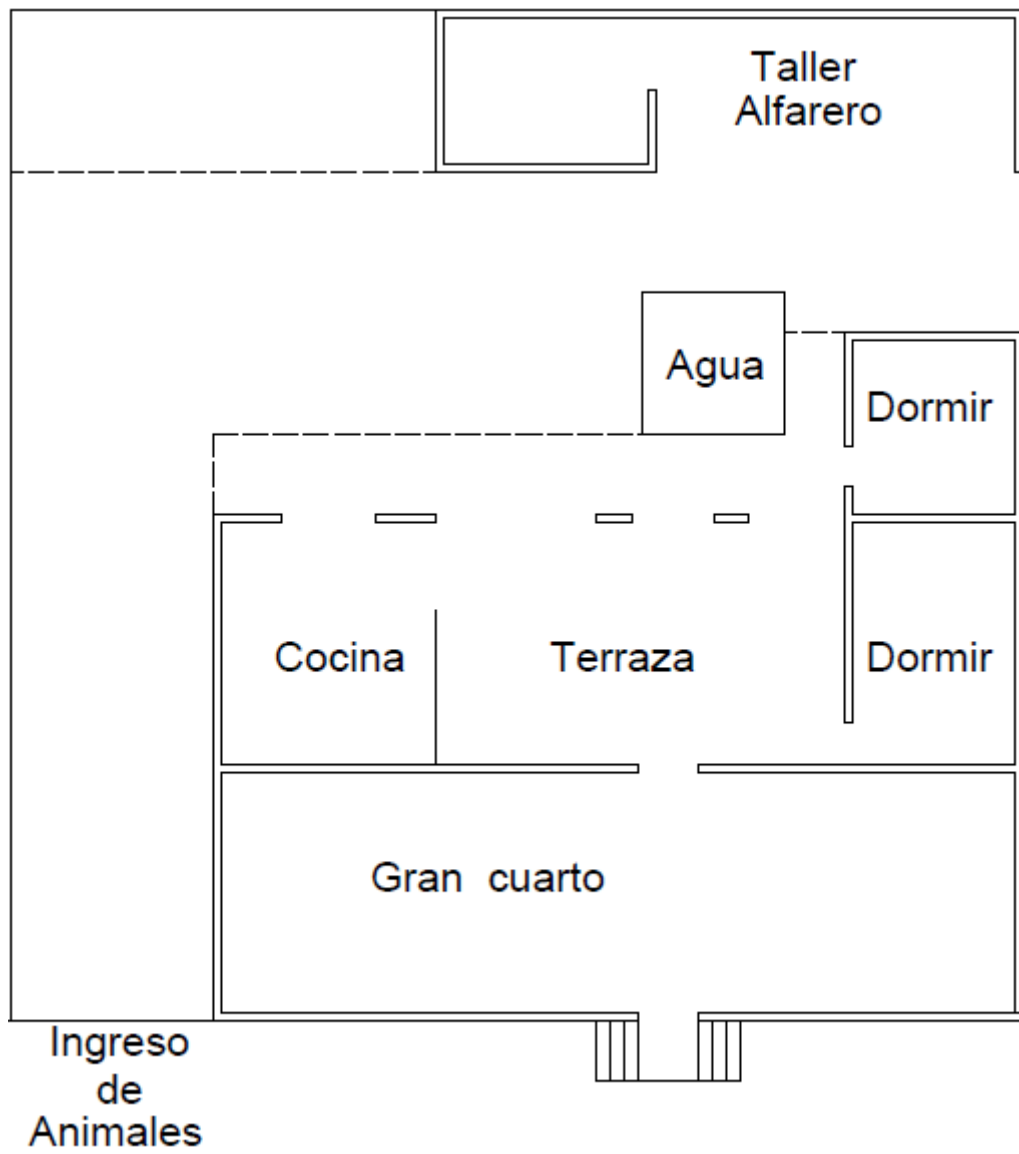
Esquema de la planta arquitectónica de una casa del s. XVI. Dibujo del autor.
